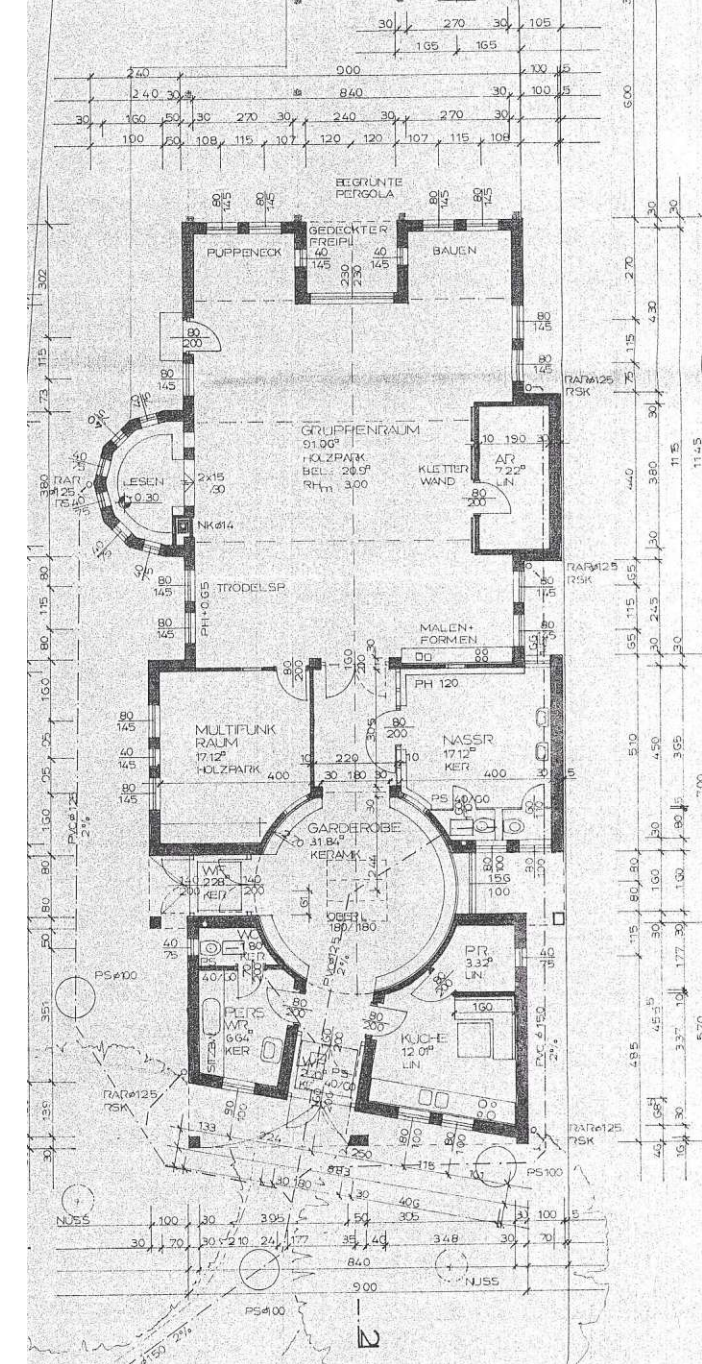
Grundriss Kindergarten Bestand 1:200
